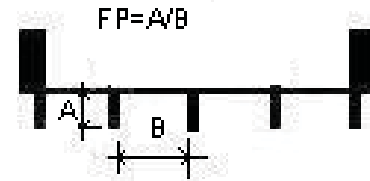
Factor de protección de pantalla solar vertical (vista planta)
